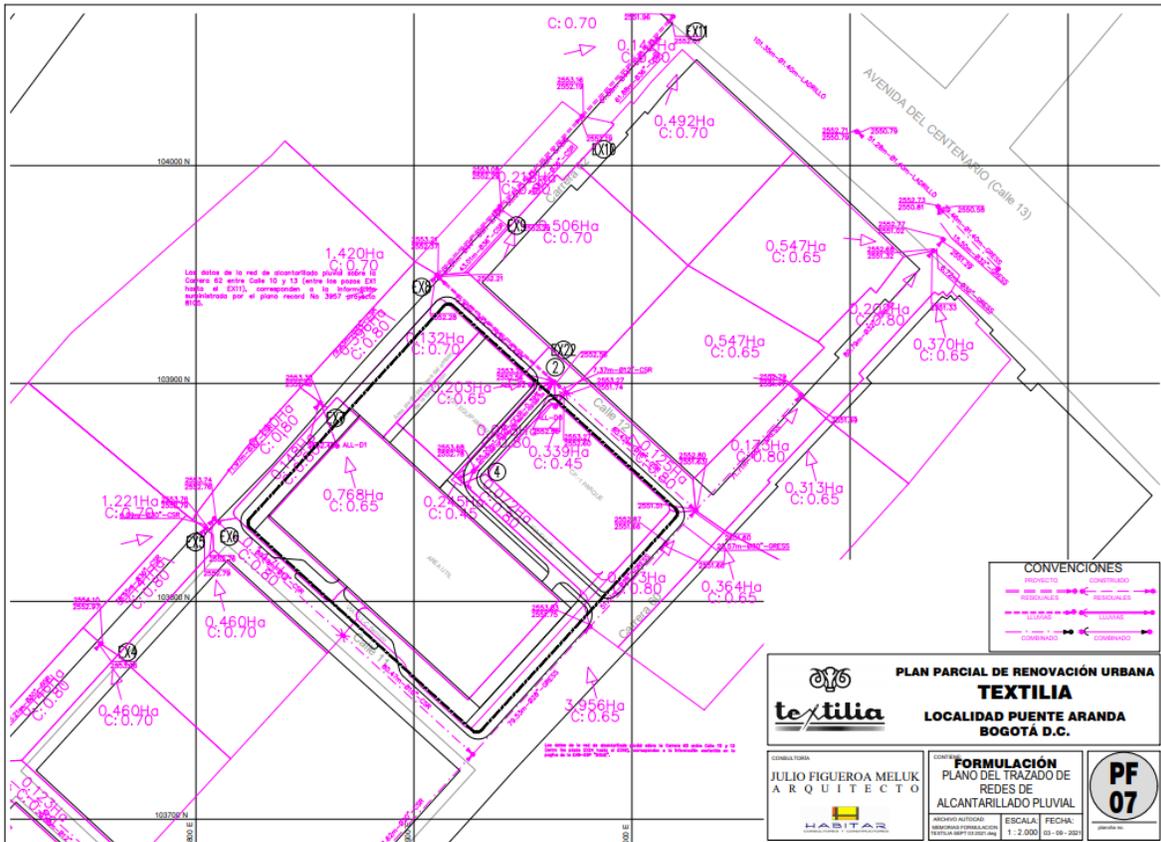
PF 07 Trazado de Redes de Alcantarillado Pluvial
